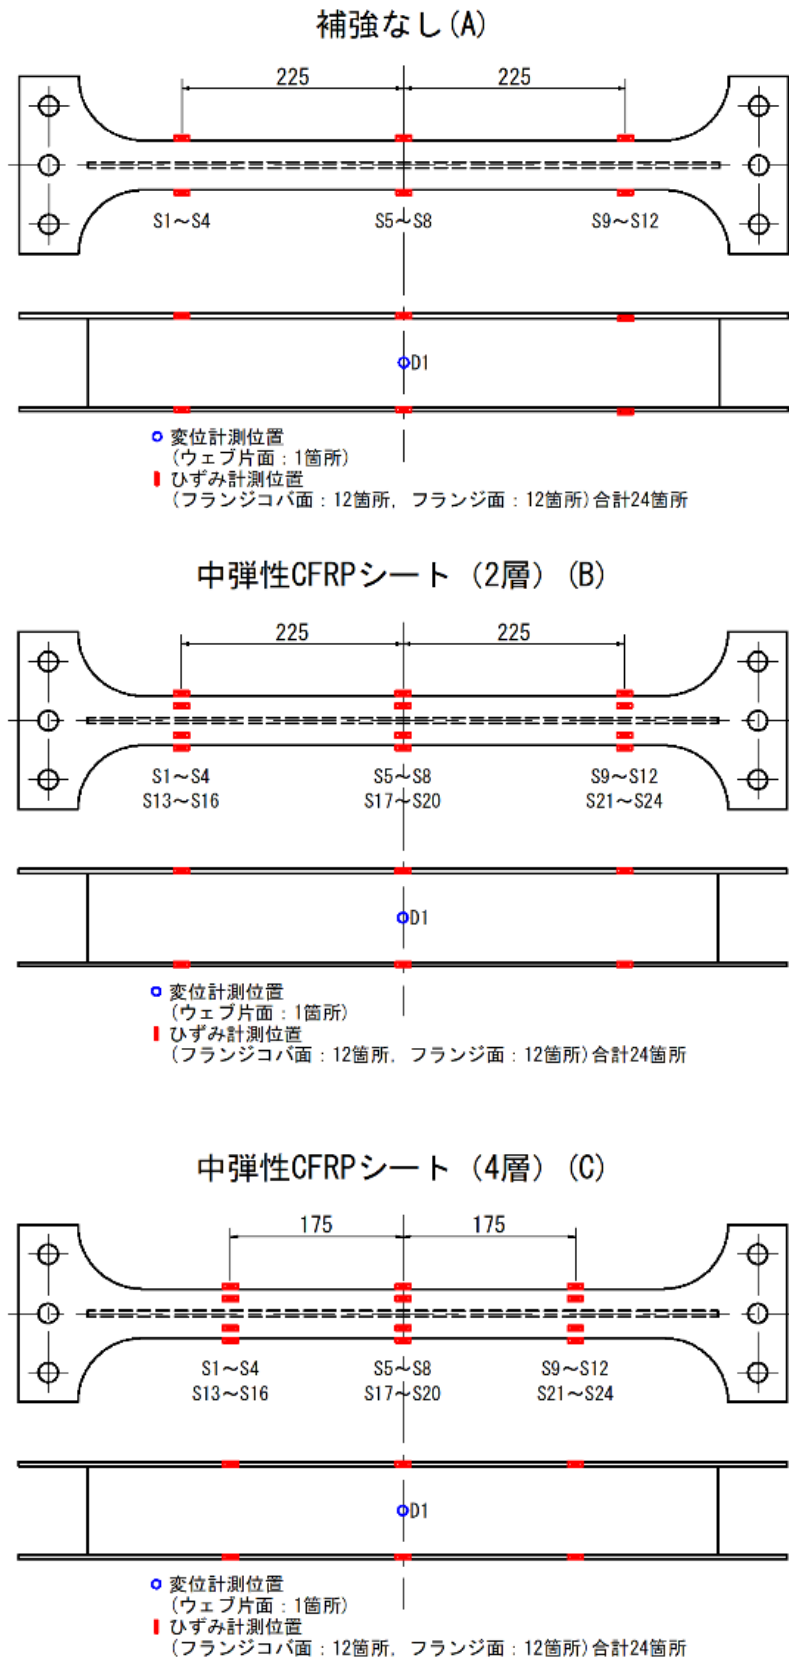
ひずみゲージの貼付位置と変位計測値 (単位: mm)
